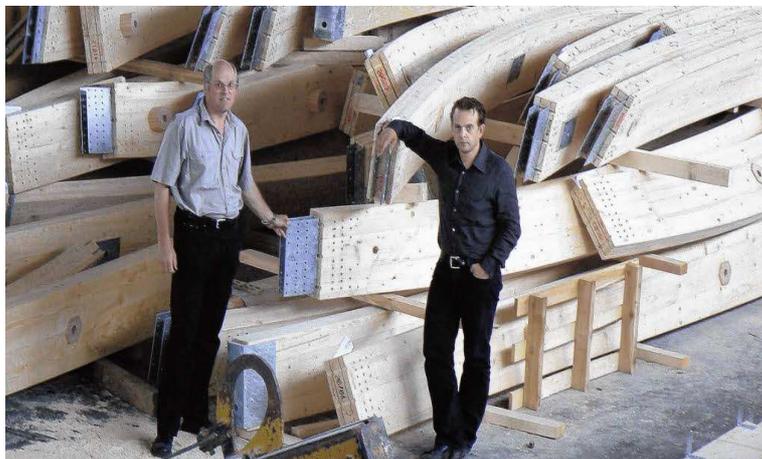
Elemente mit eingezinkten Stahlblechen
